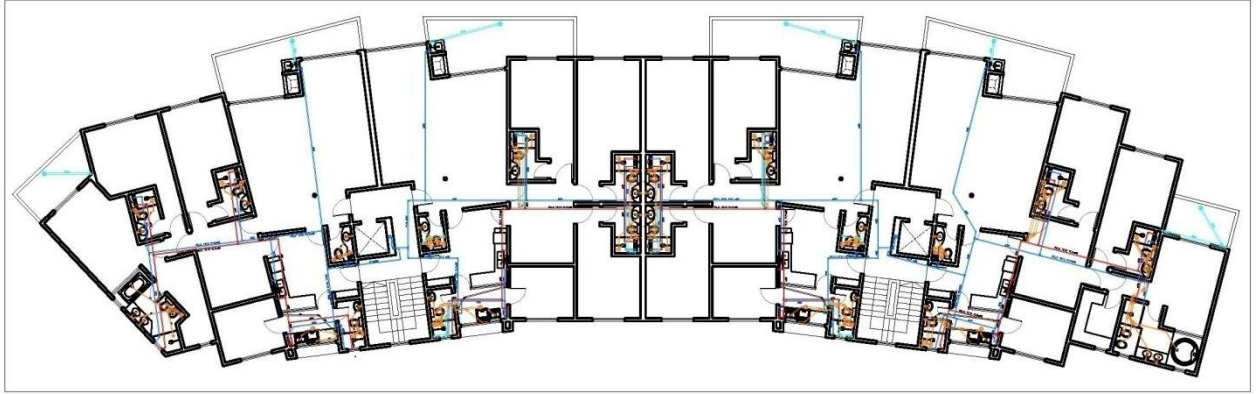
Planta baixa do projeto hidro-sanitário do pavimento tipo do bloco 02.
